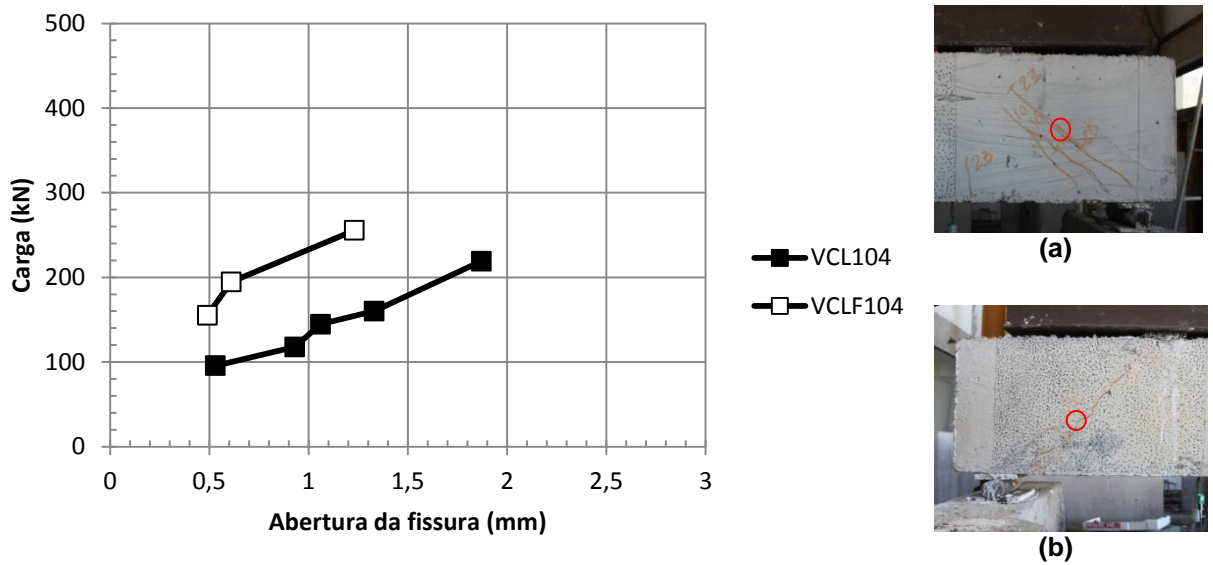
Evolução da abertura de fissuras nas vigas-parede: a) VCL104 e b) VCLF104.
